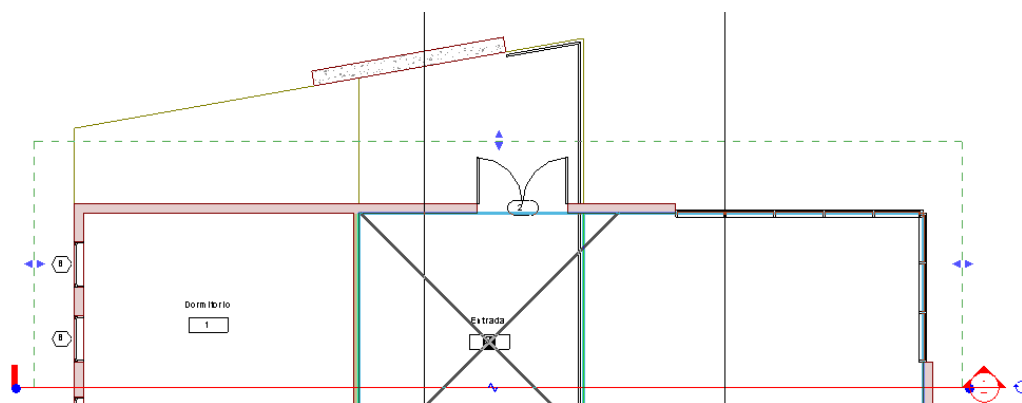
Control gràfic de l'extensió en planta d'una secció.
